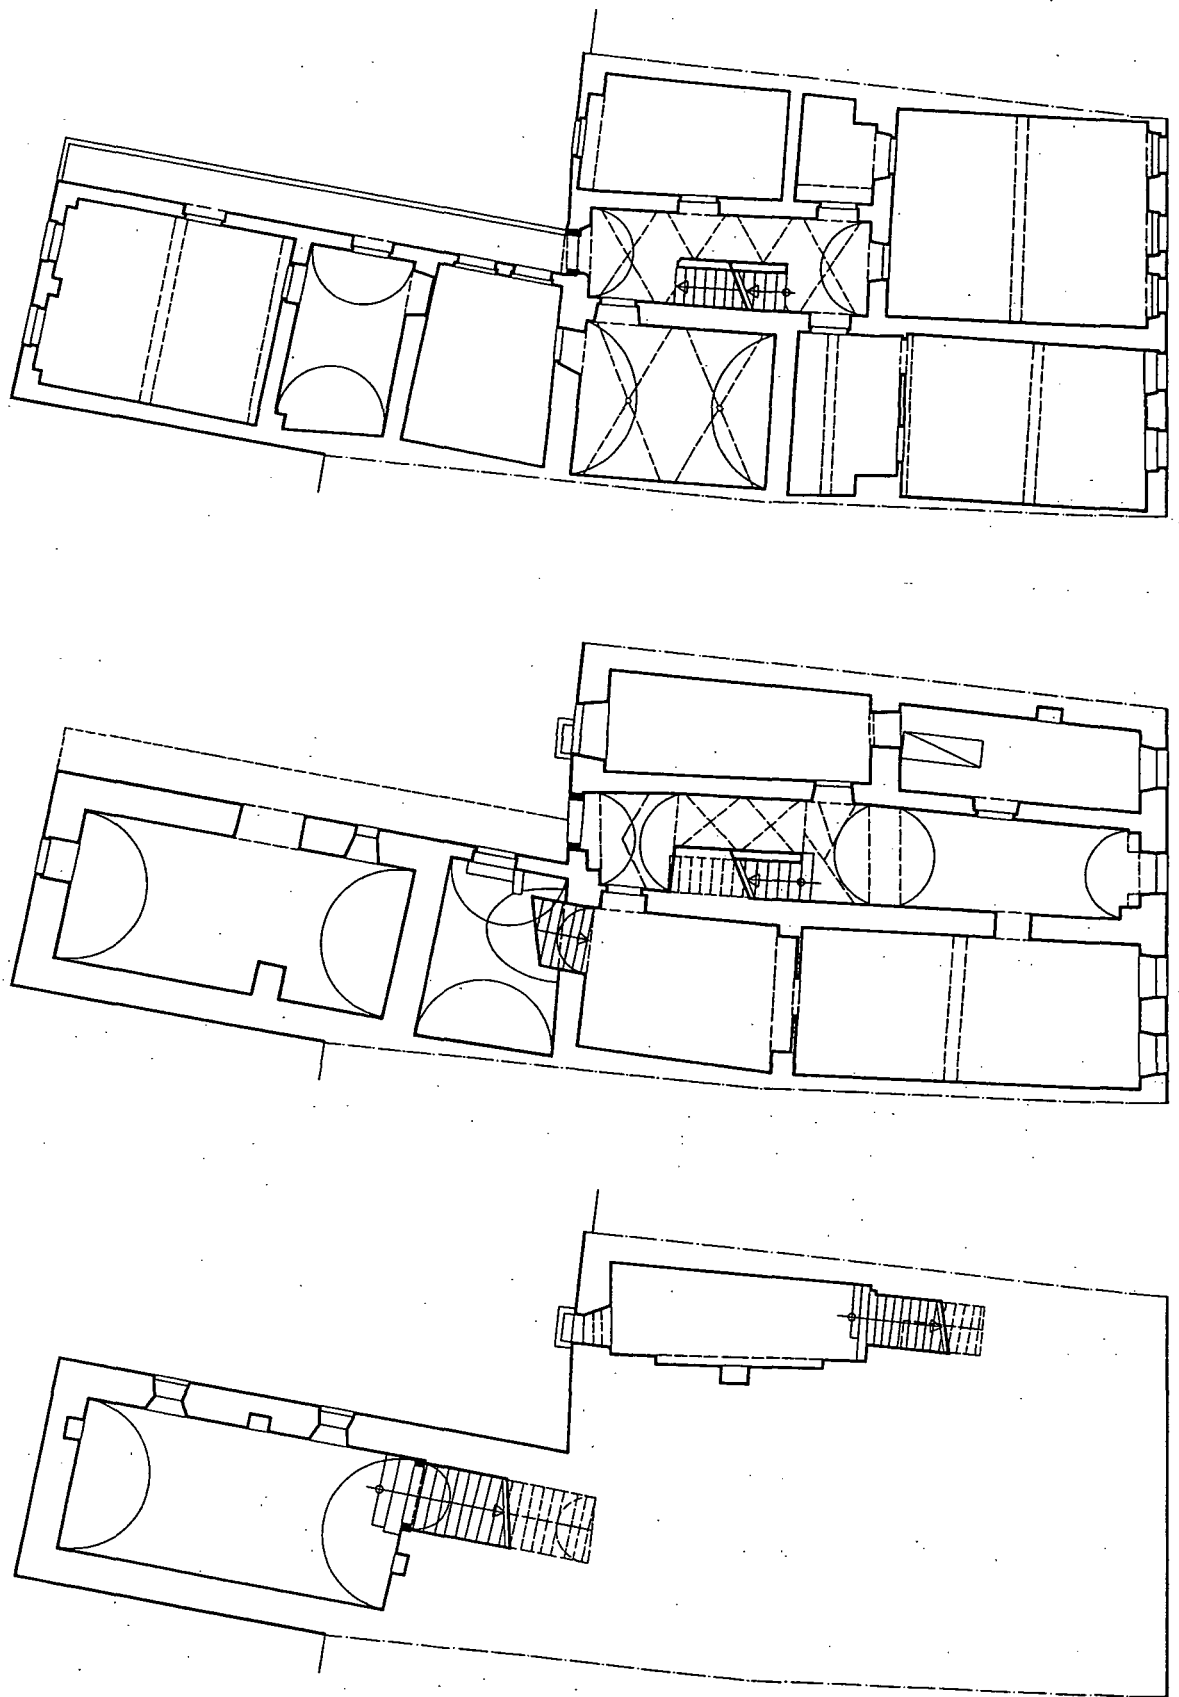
Schmiedstraße 13 – Grundrisse Keller, Erdgeschoss, Obergeschoss (1:200).
